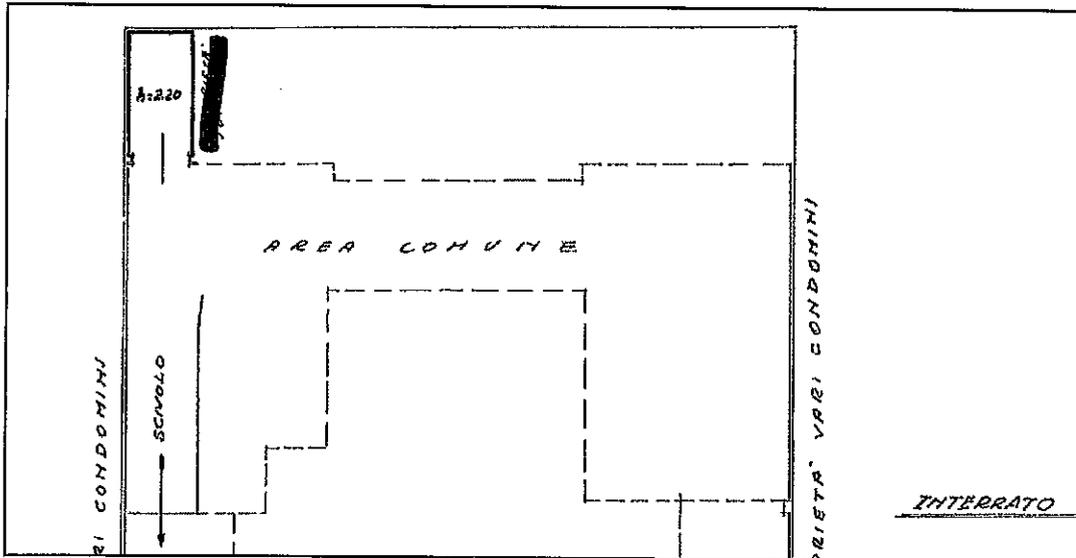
stralcio della planimetria catastale part. 182 sub 20 (autorimessa)
